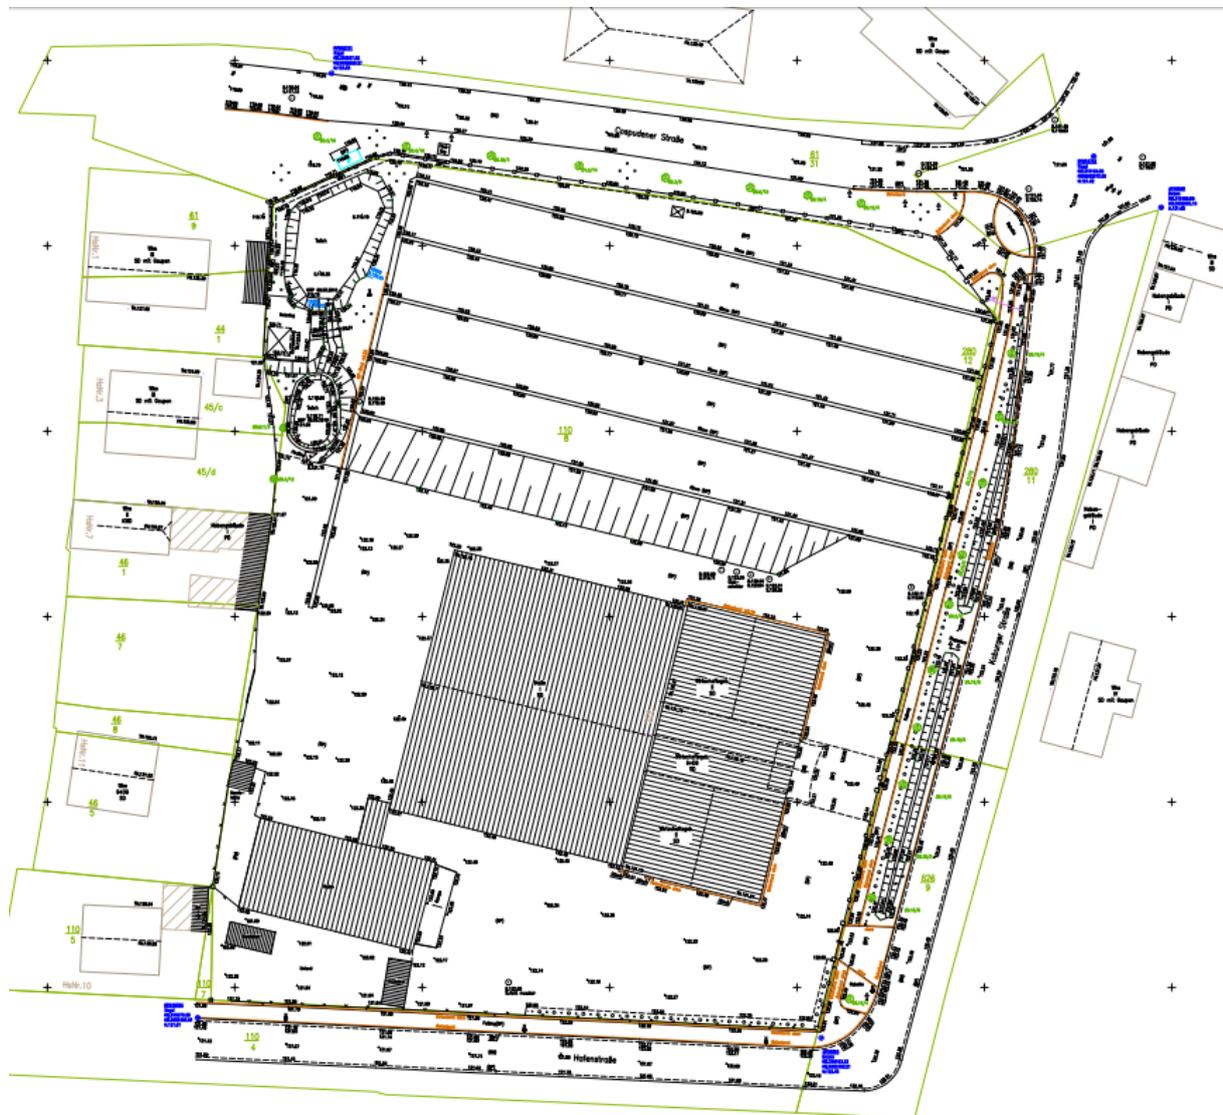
Bestandsplan des Plangebietes (Stand März 2019)
